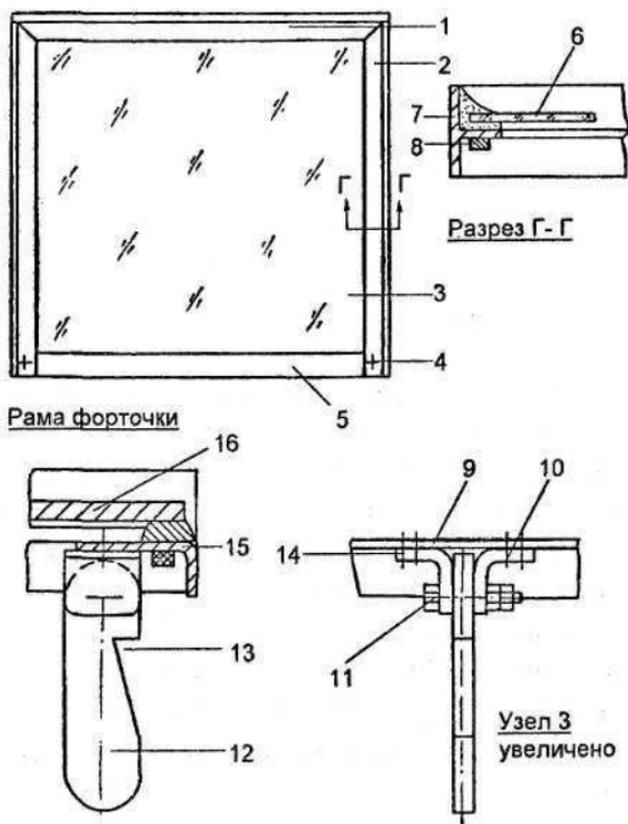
Технология изготовления коробки для форточки в крыше и стене:
